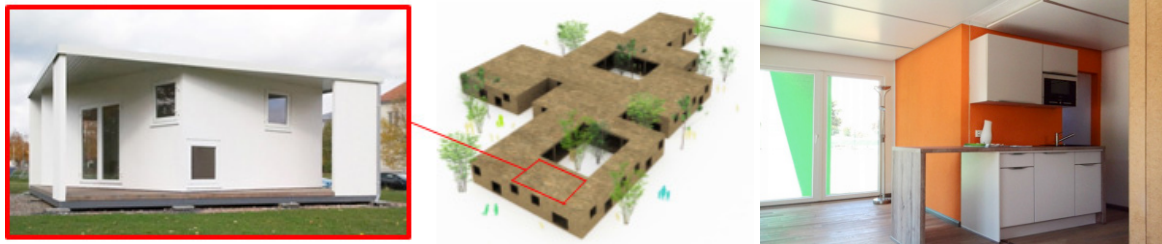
EcoHouse als Beispielanwendung für Sandwichstrukturen mit Naturfaser-Decklage (Baujahr 2013)
